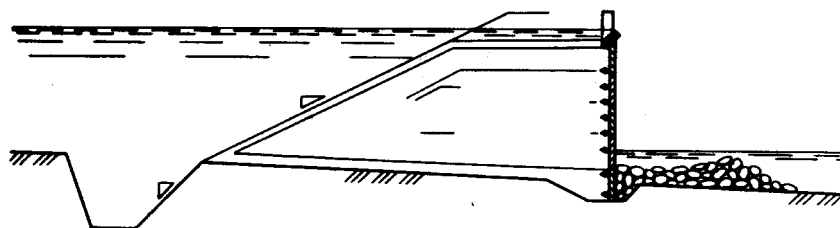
Плотина из армированного грунта [Кассард и др., 1979]
